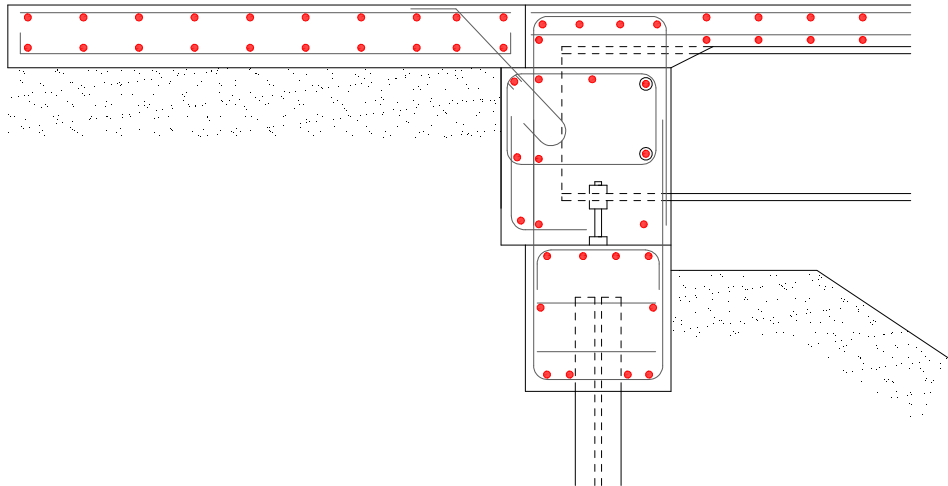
Connessione sovrastruttura in acciaio – spalla, *schema 1
